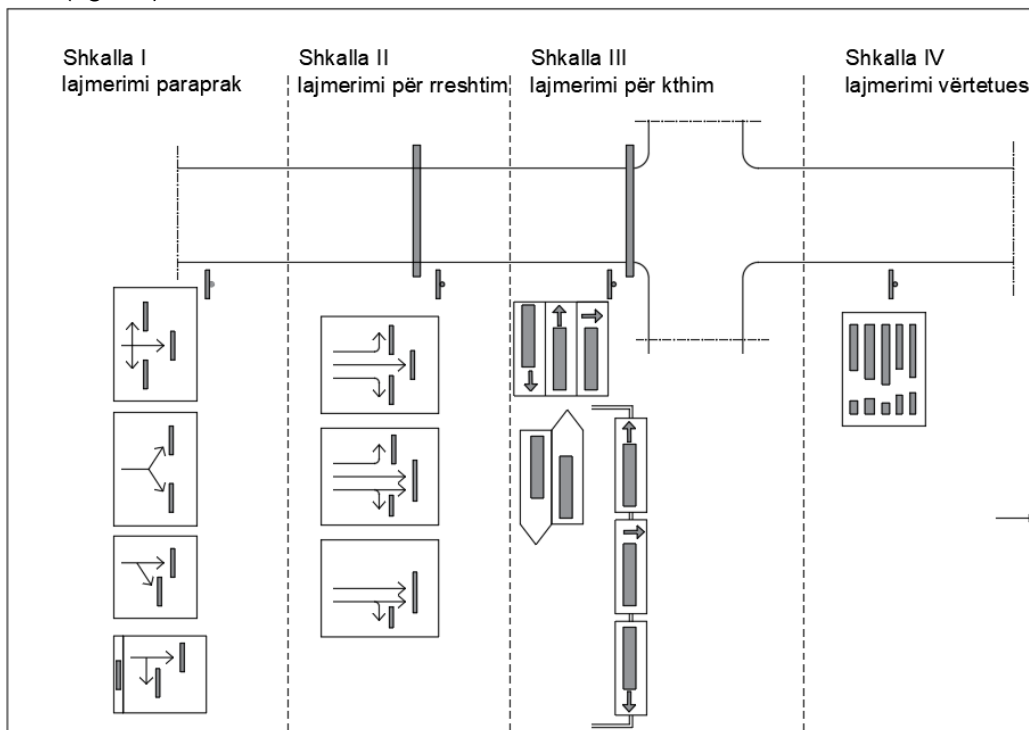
Paraqitja e shenjave udhëtrëguese sipas shkallëve të lajmërimit
